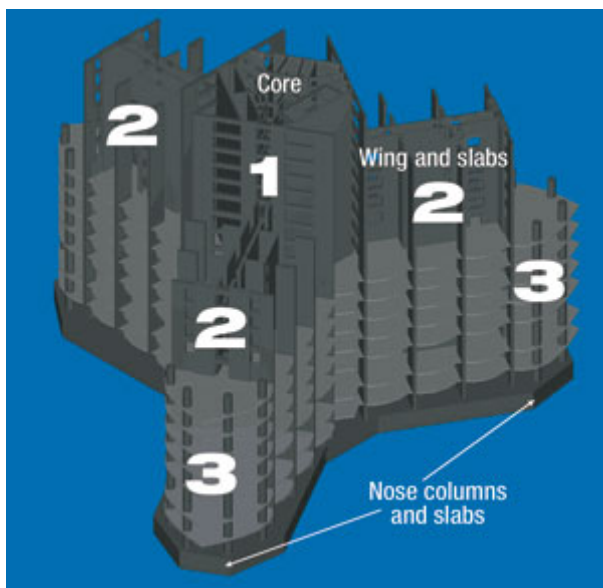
Overgang beton-staal Burj Khalifa [1]
